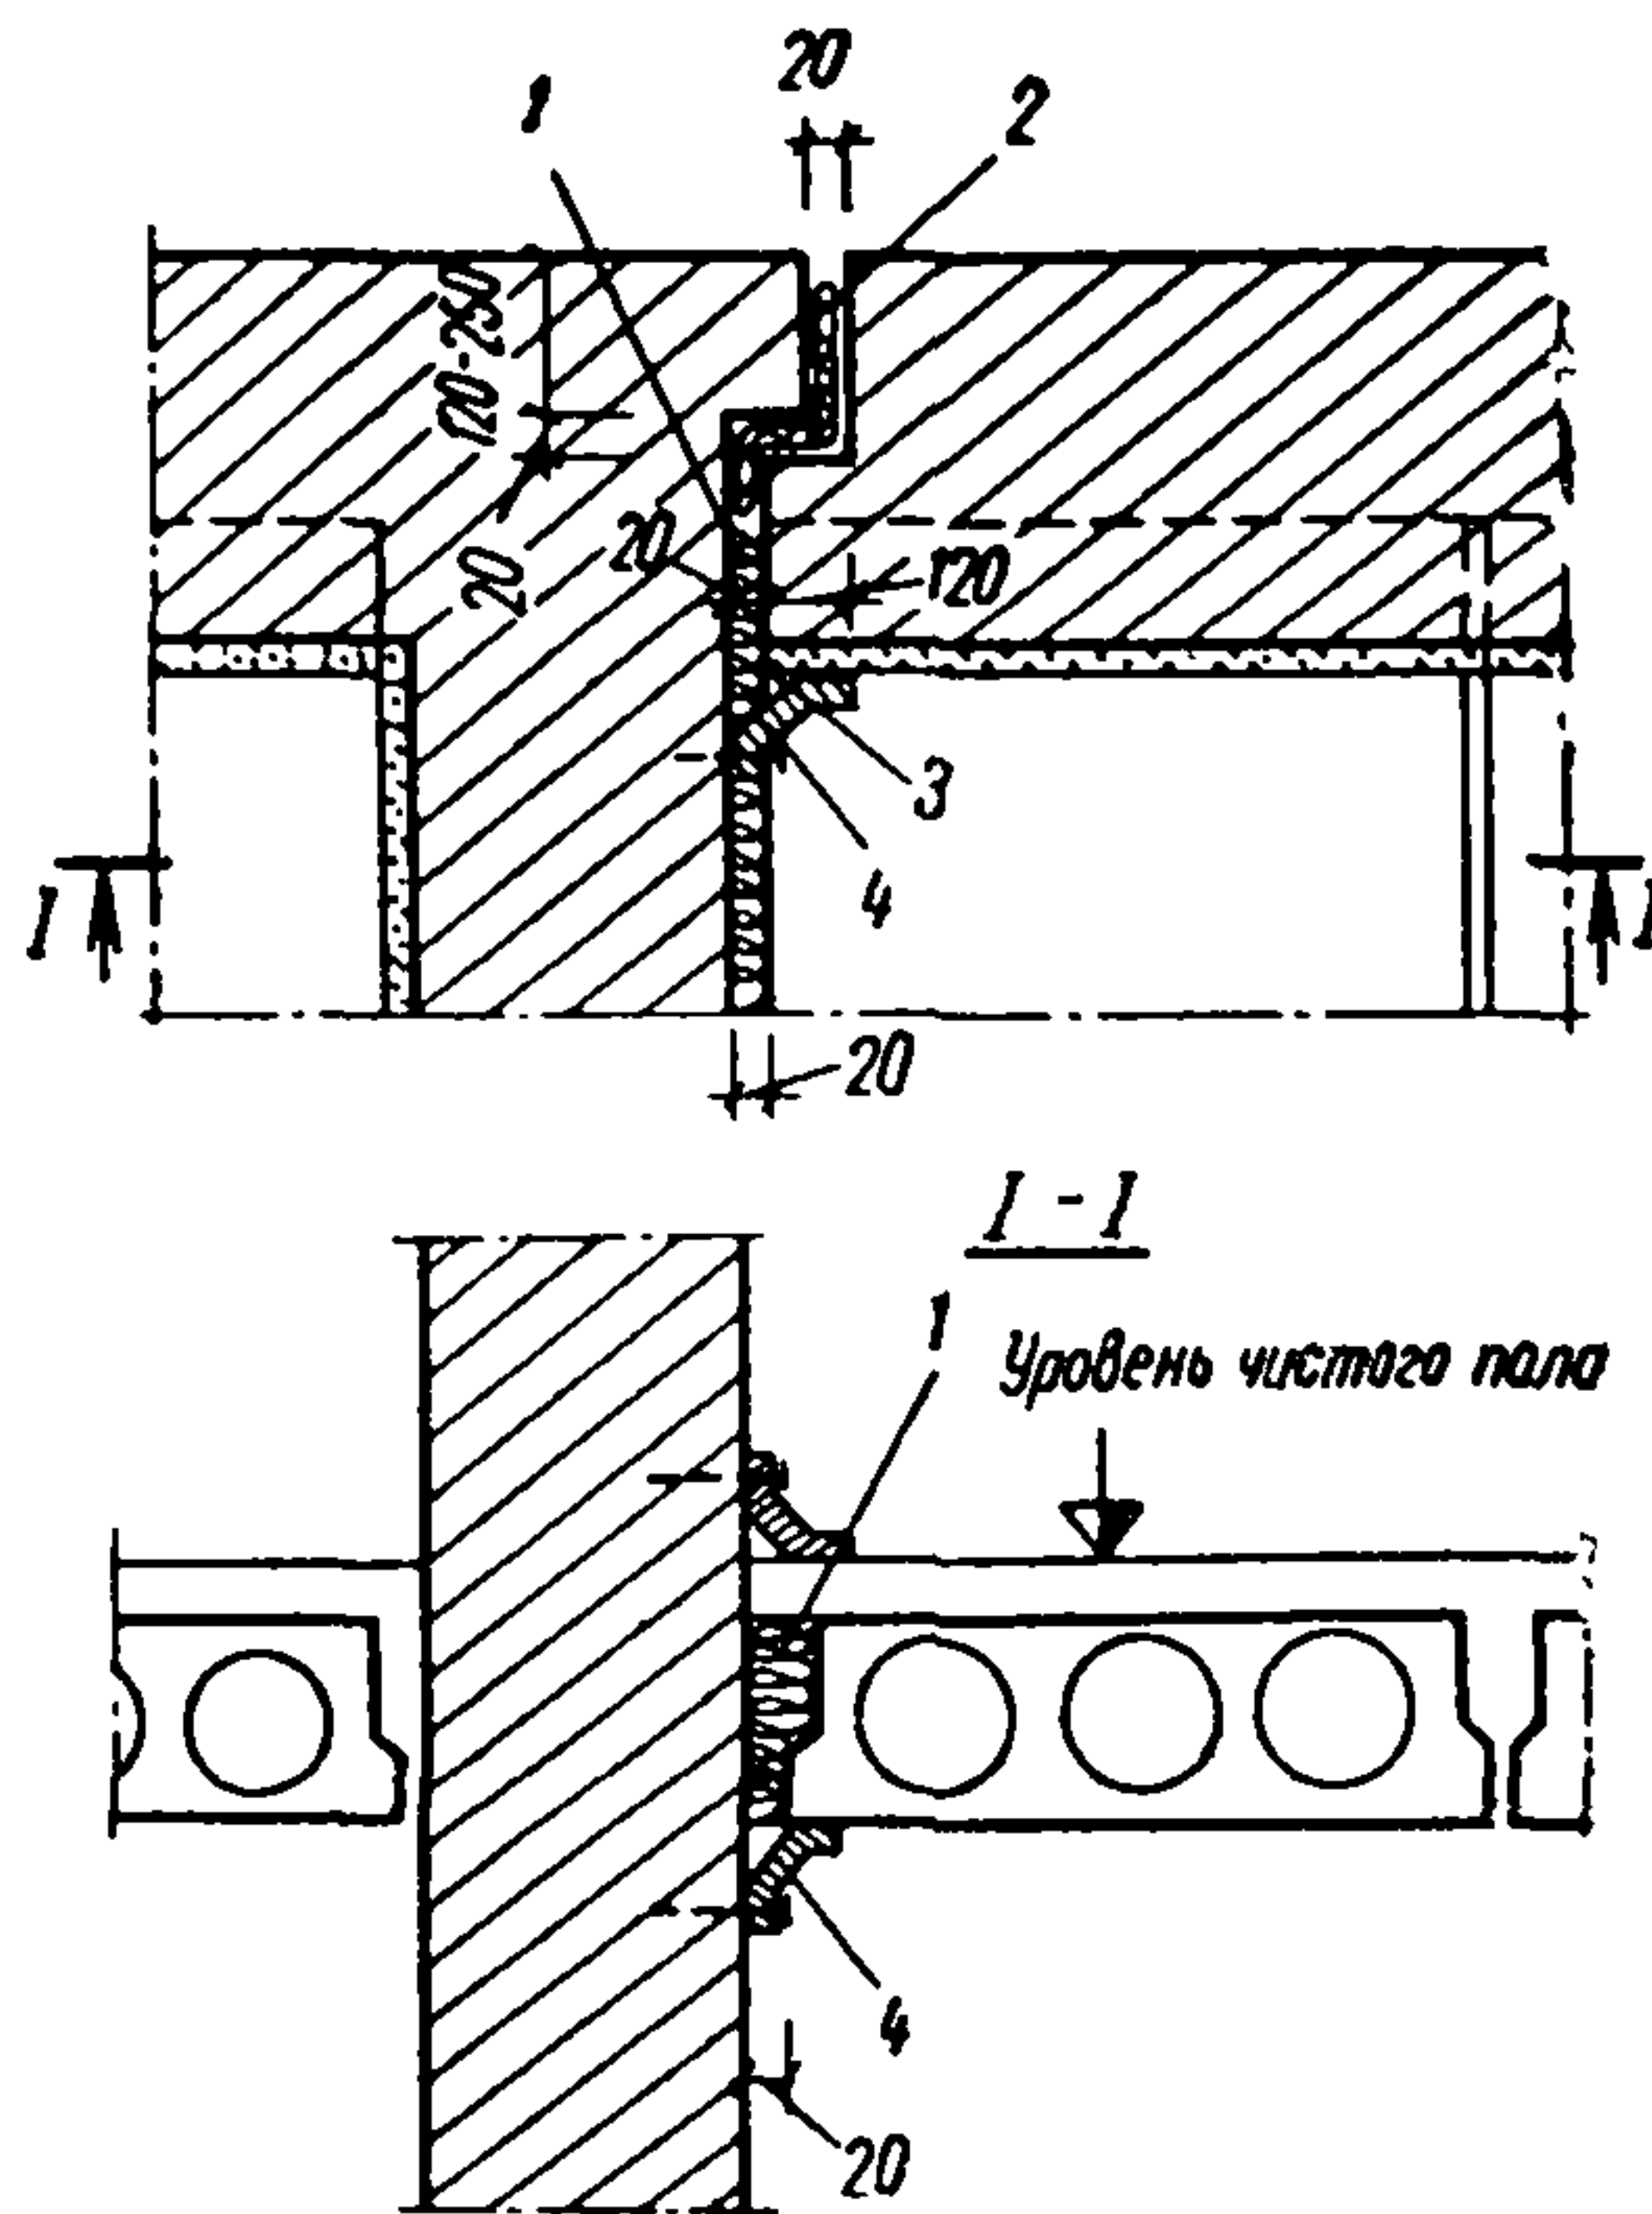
Температурные швы в зданиях с продольными несущими стенами
